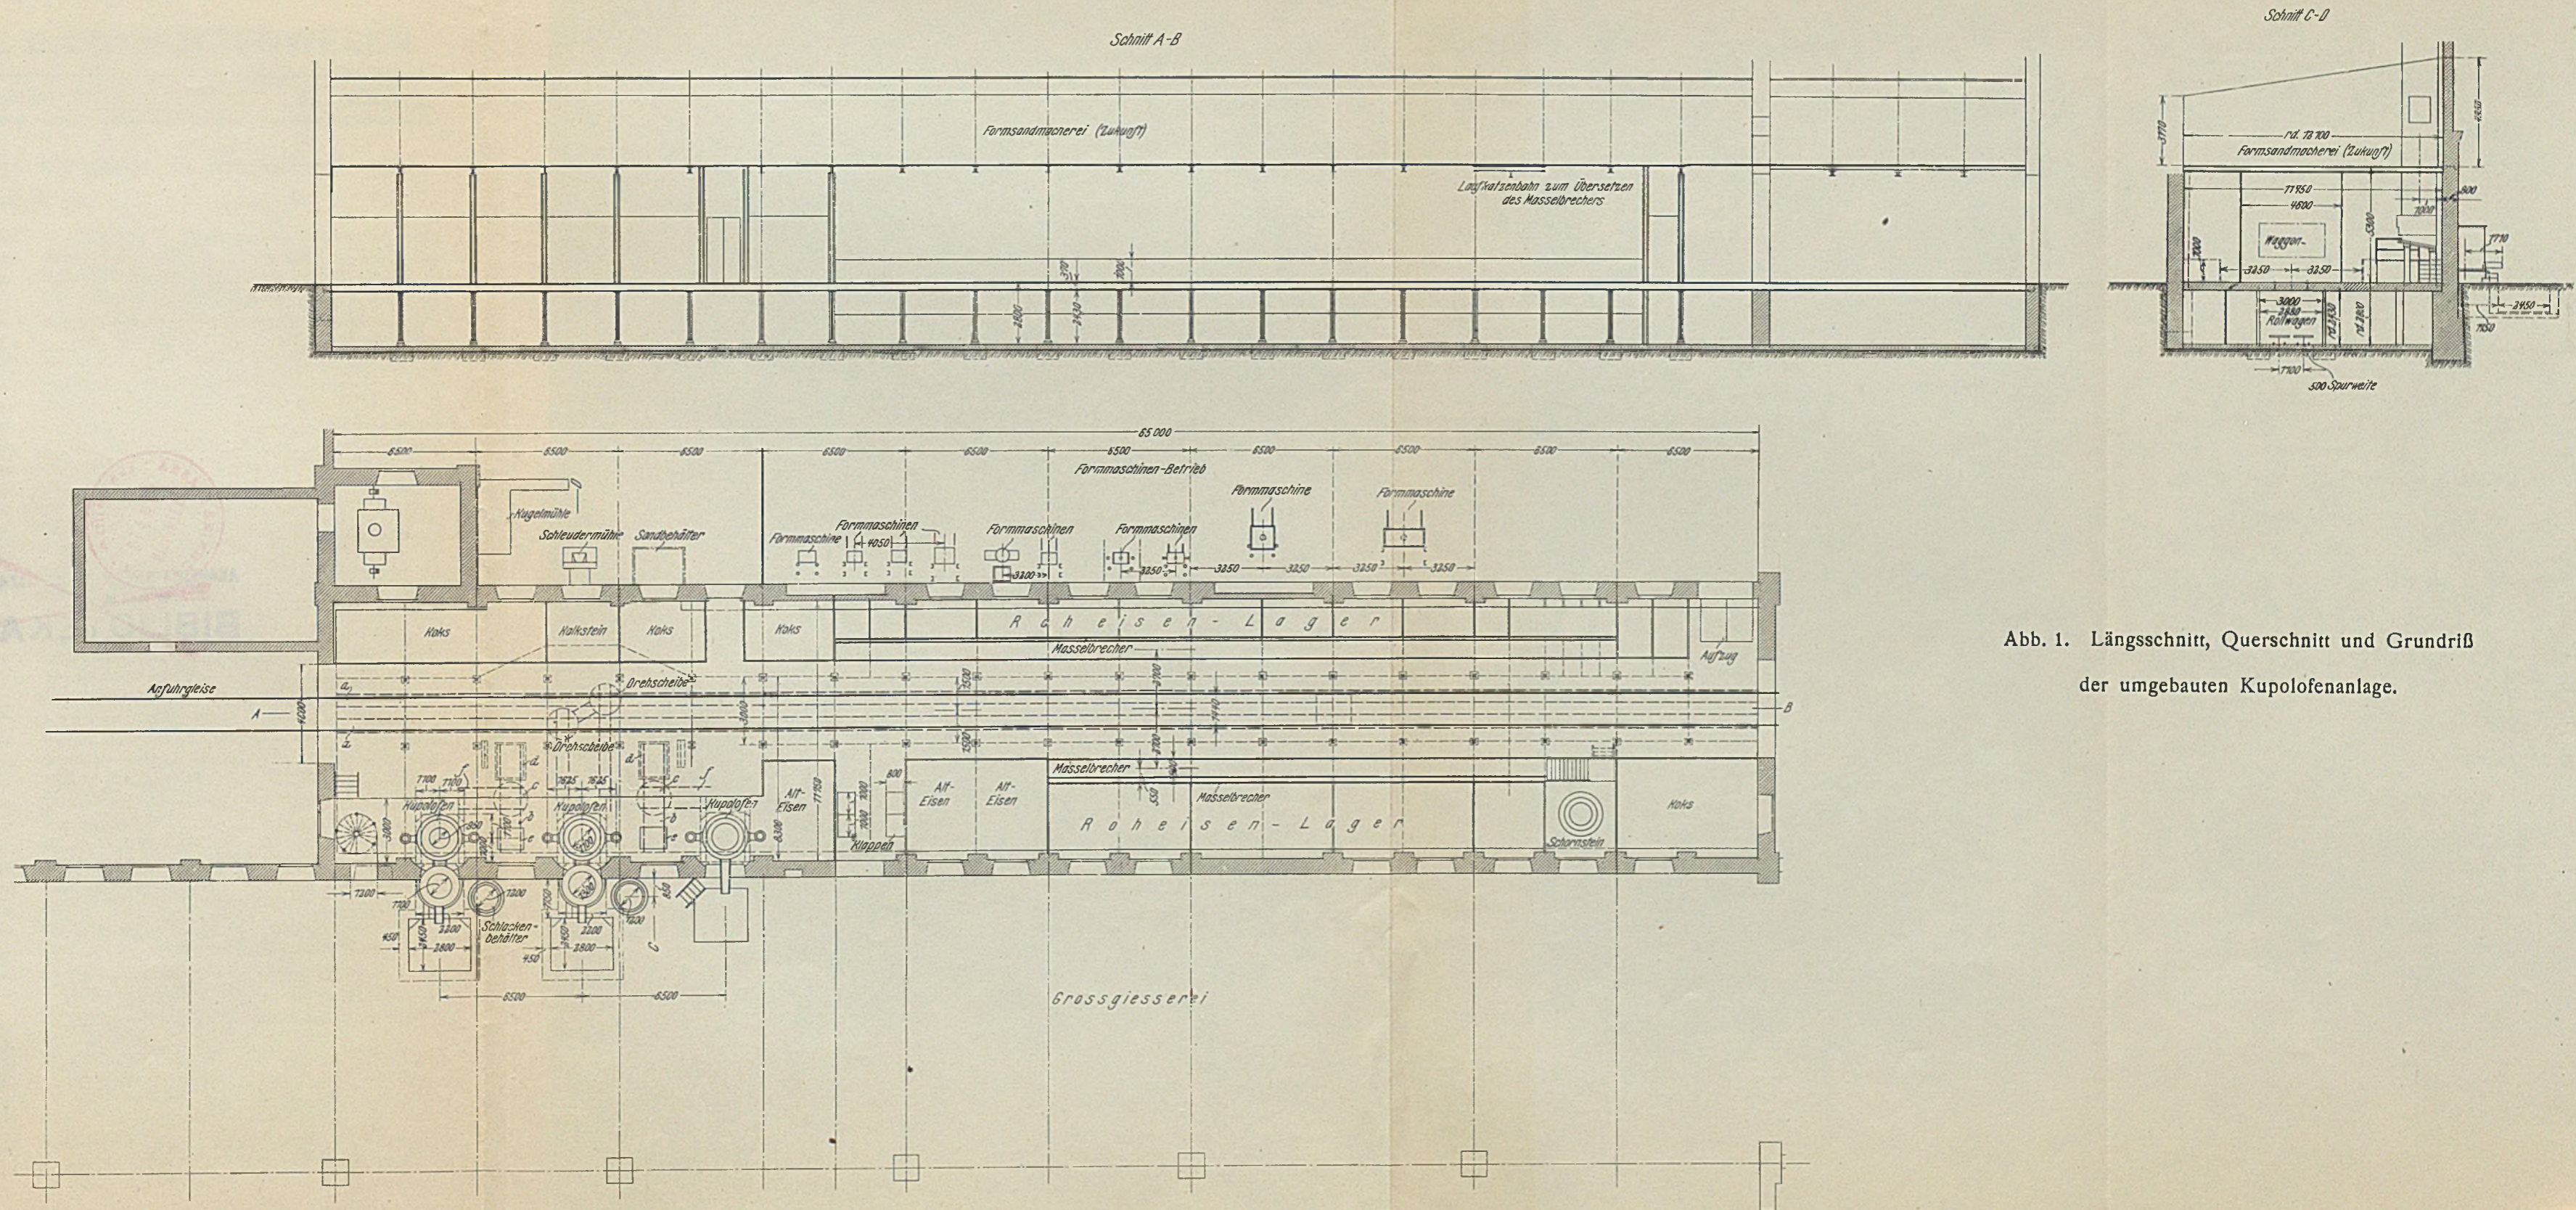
Längsschnitt, Querschnitt und Grundriß der umgebauten Kupolofenanlage.
